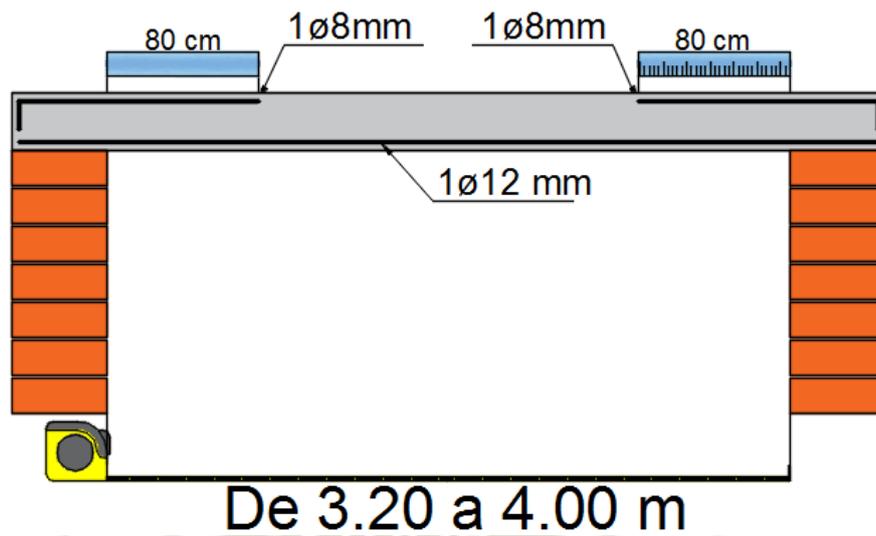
Refuerzo de vigueta hasta 4.00 m.
